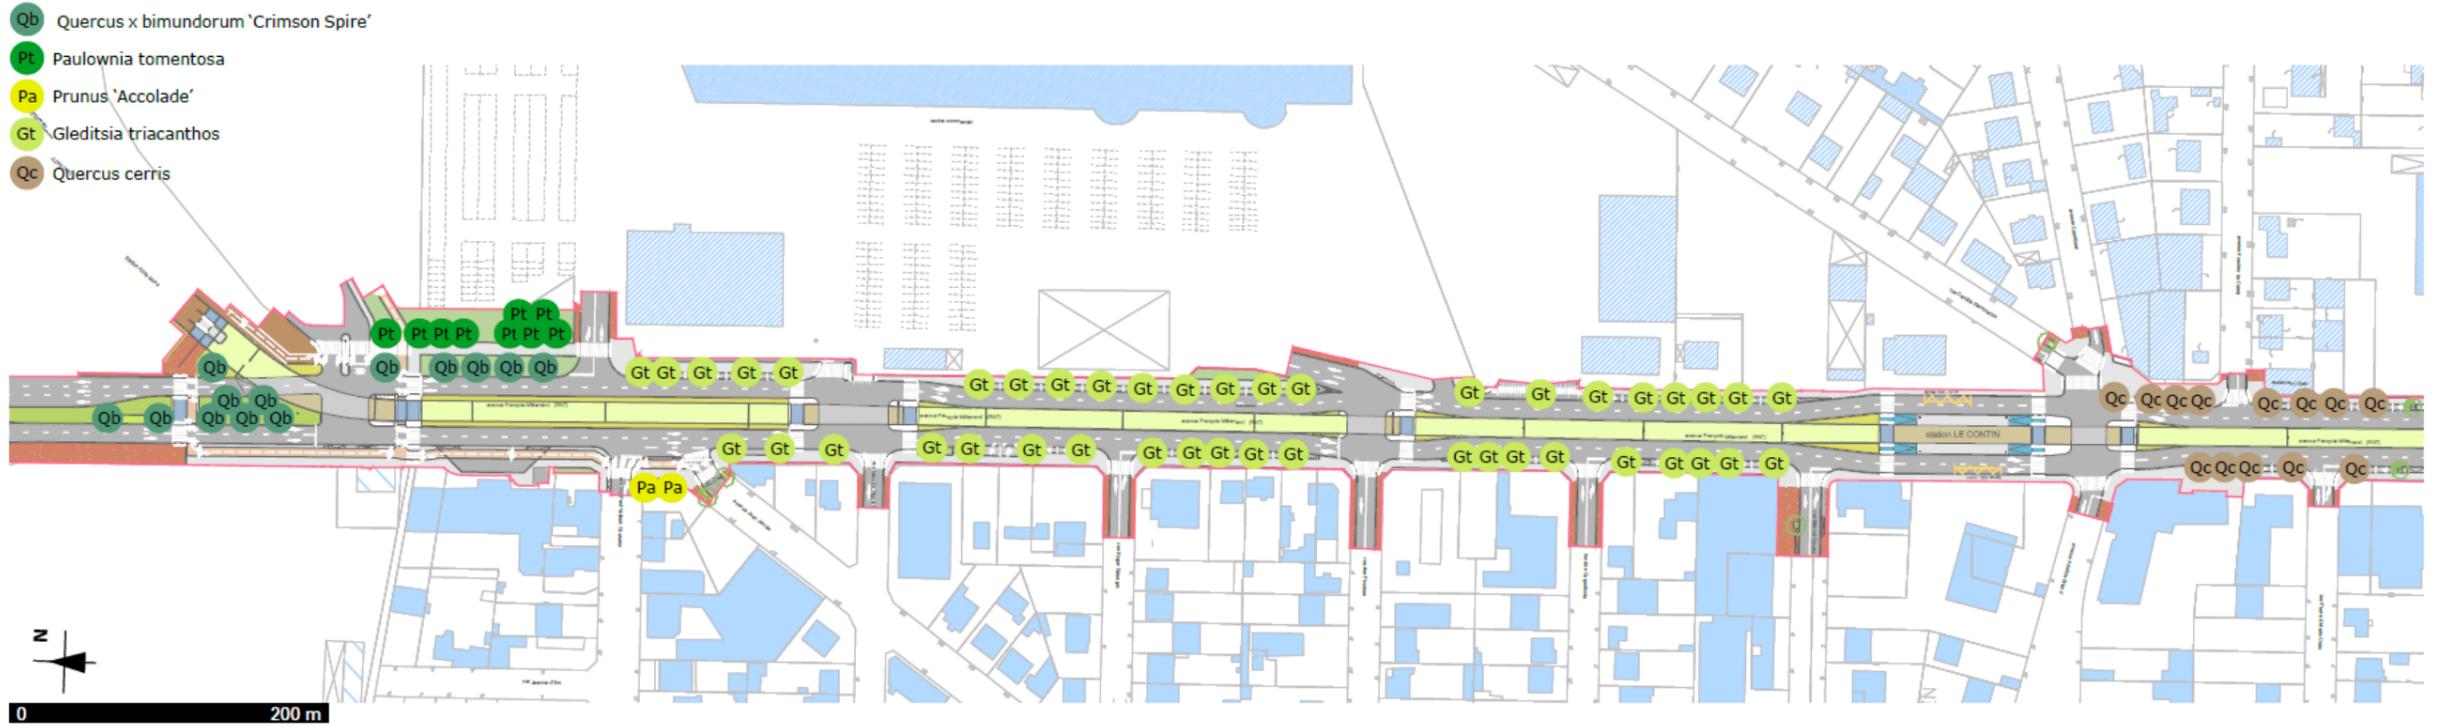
Plantations prévues le long de la RN7 section avenue François Mitterrand (planche 1/6)
